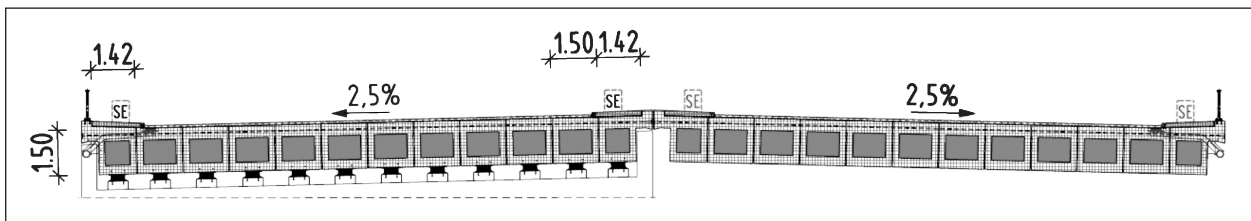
Spannbetonhohlkästen mit eingesetzten Polystyrolkörpern
